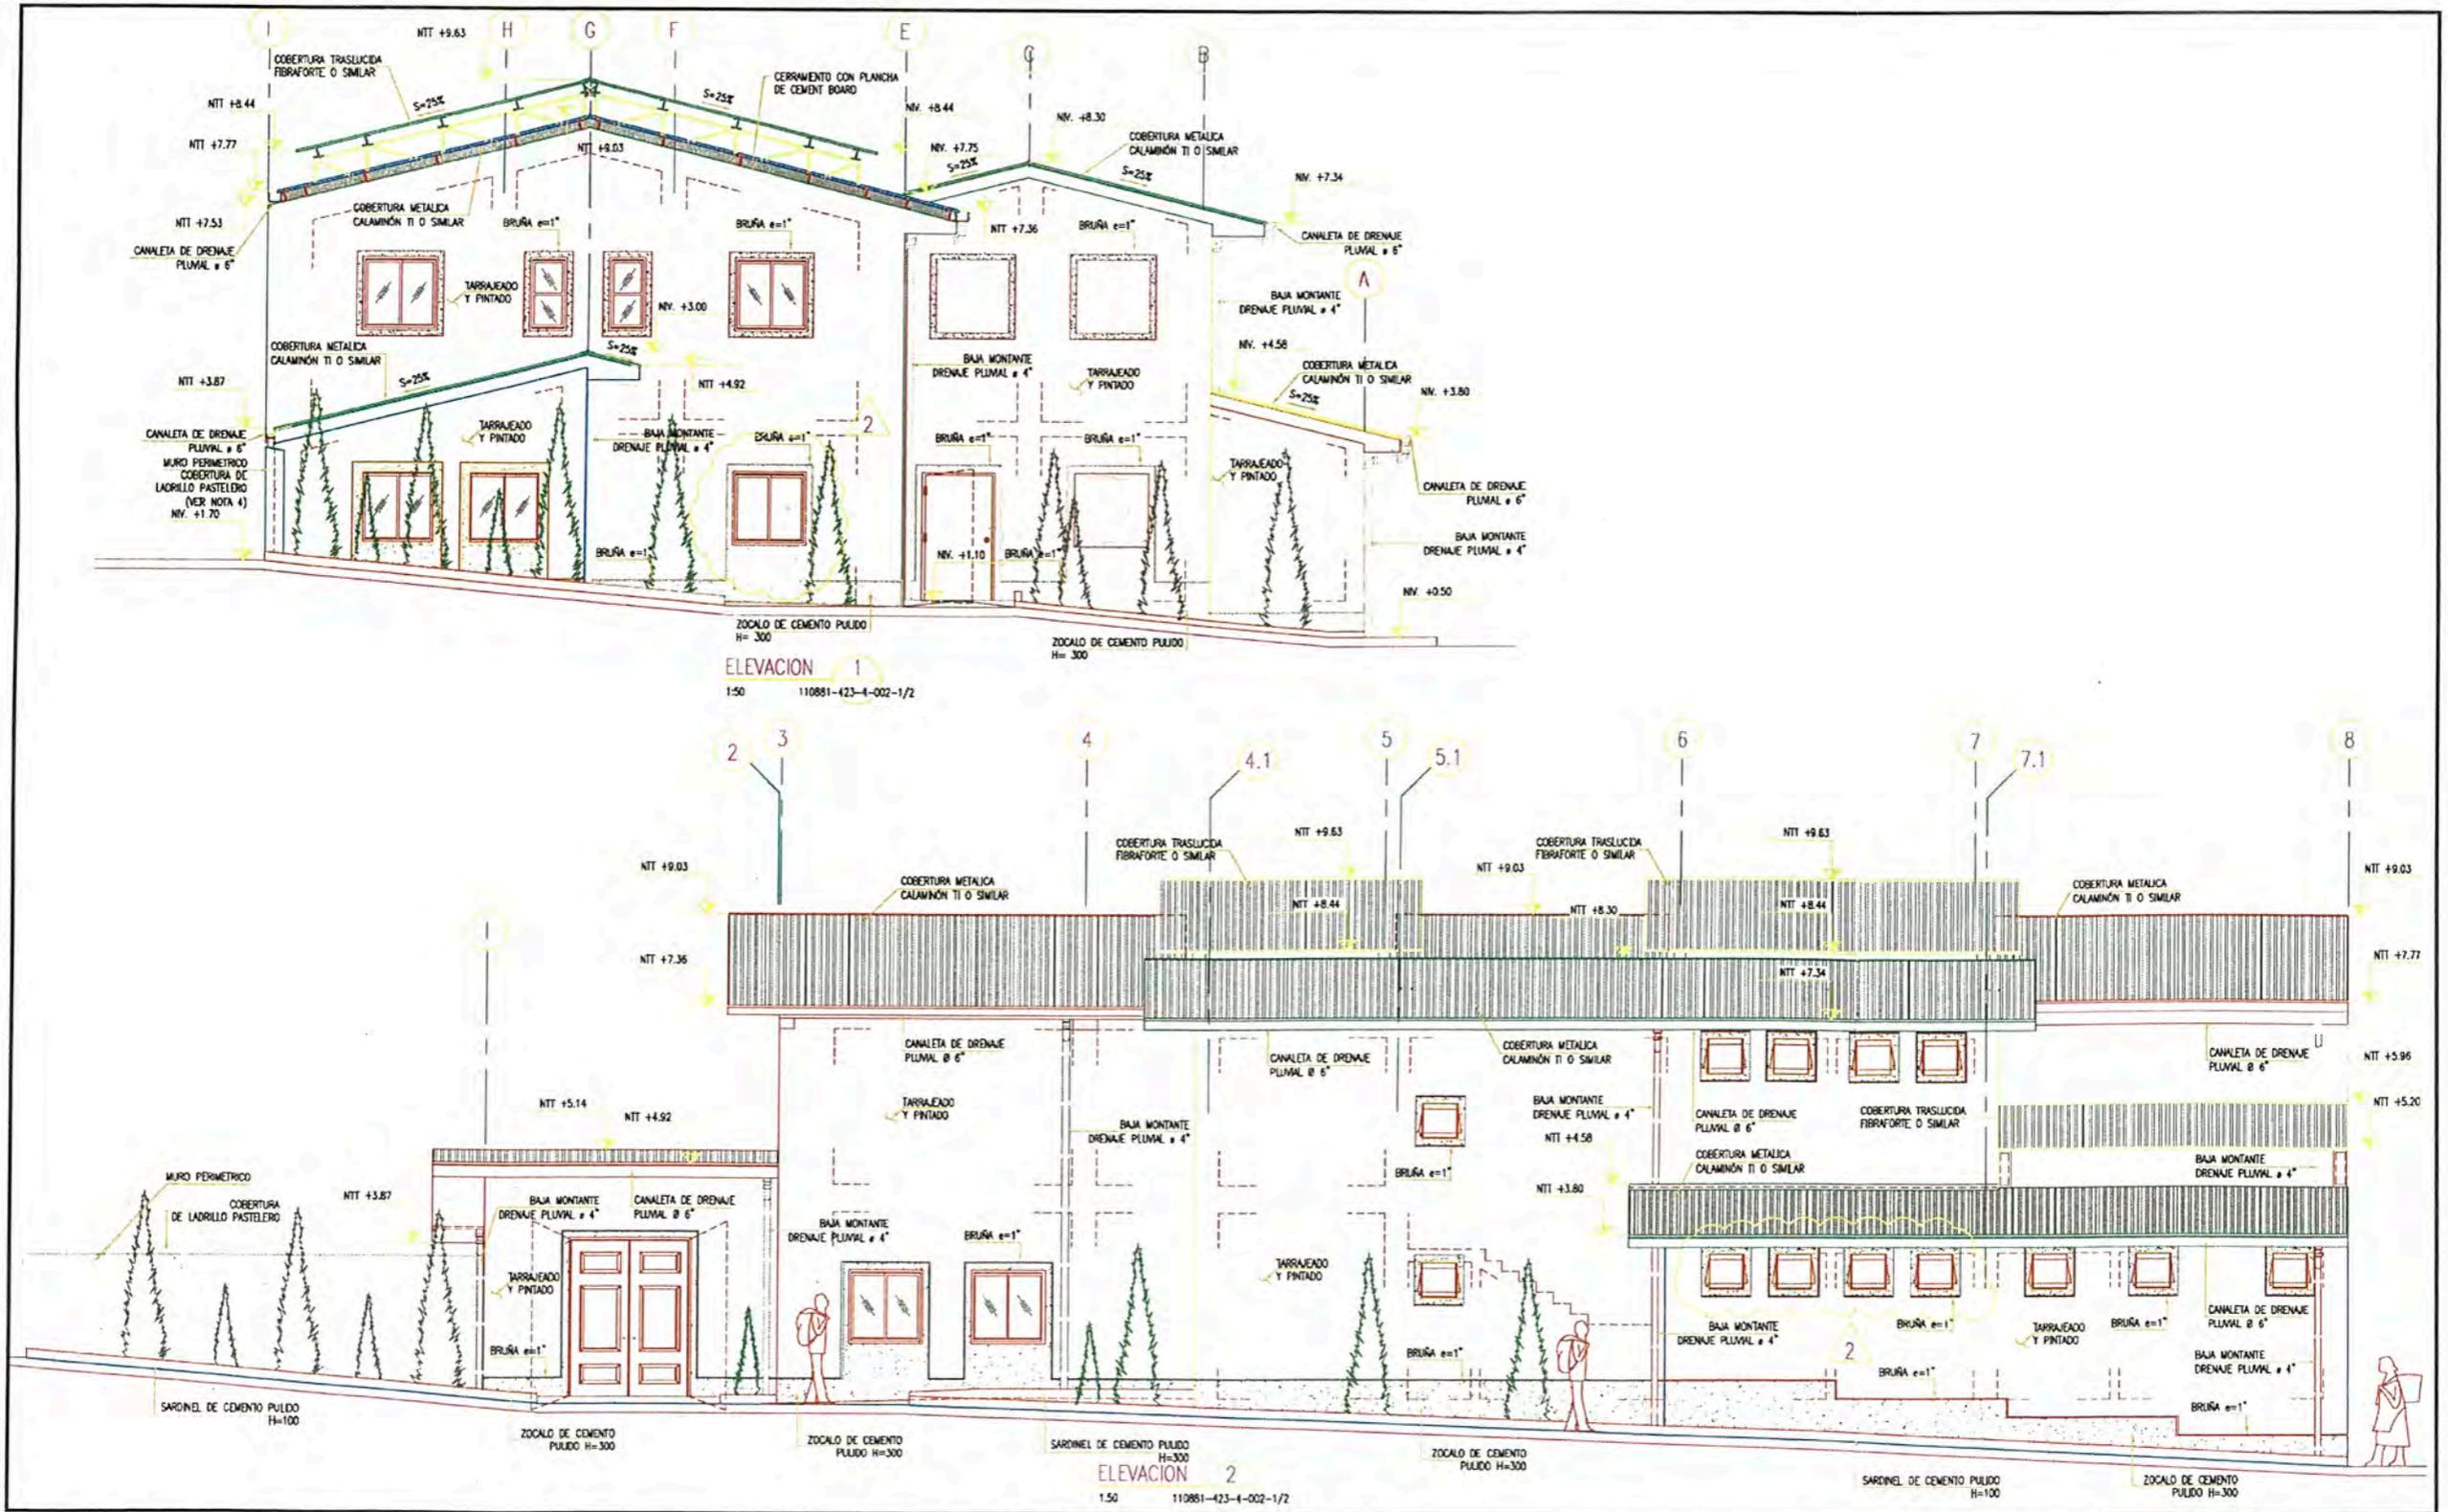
Plano de Arquitectura, Elevación frontal y lateral
